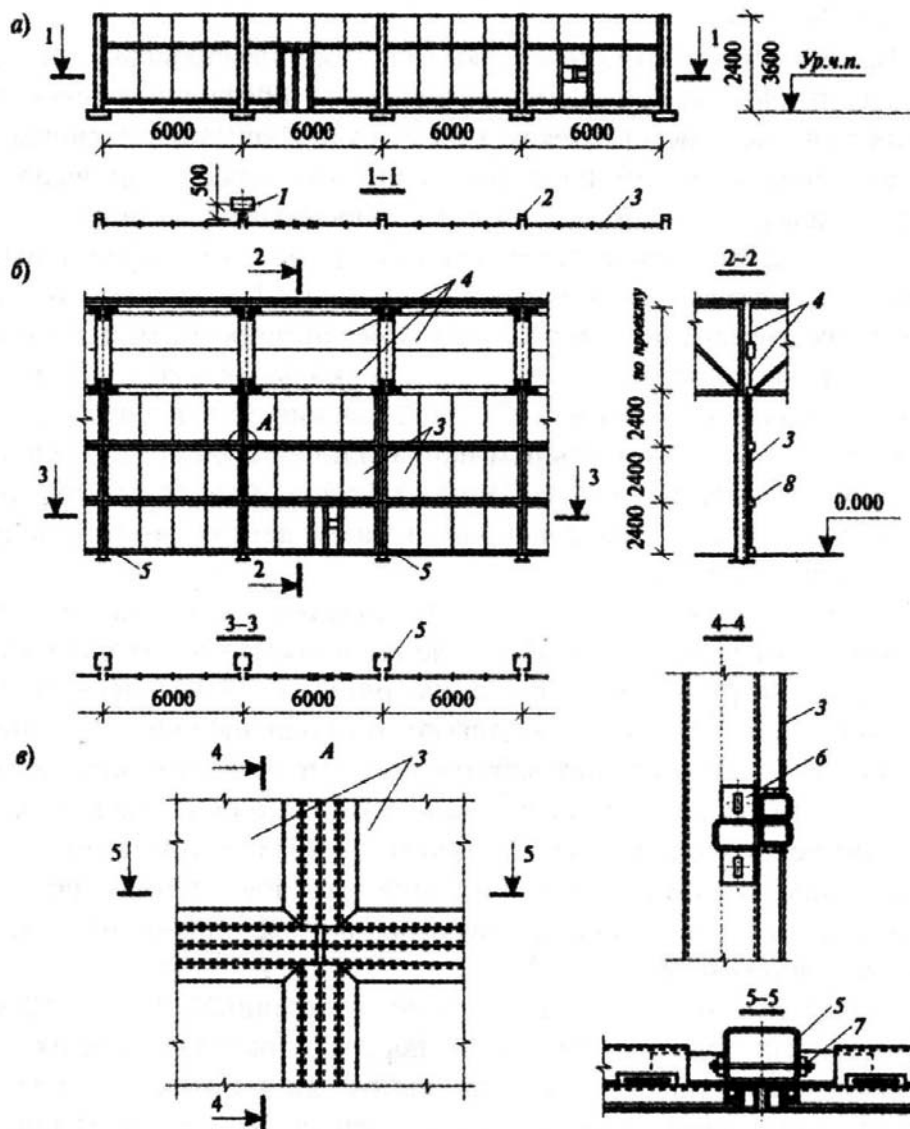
Перегородки панельные из асбестоцементных и стальных листов в стальной обвязке:
